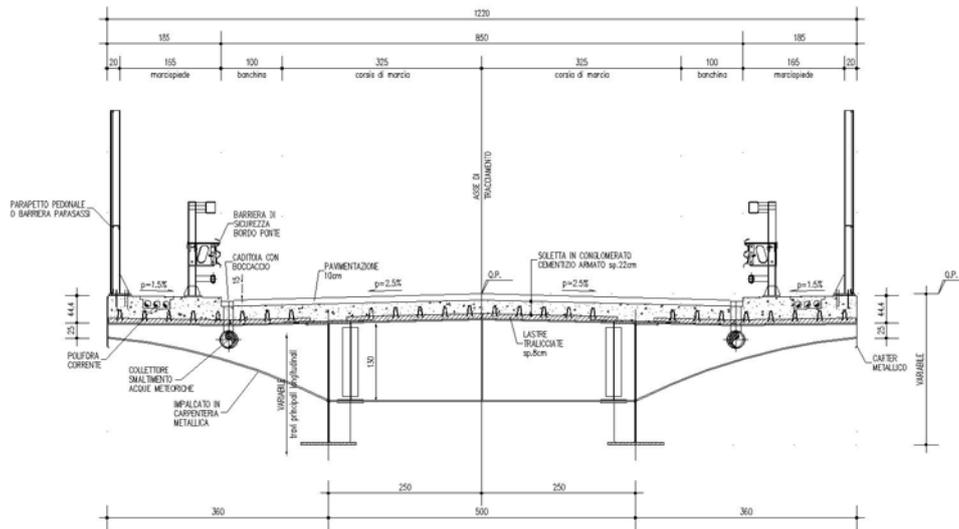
B – SEZIONE TRASVERSALE IMPALCATO CAT. C2.
